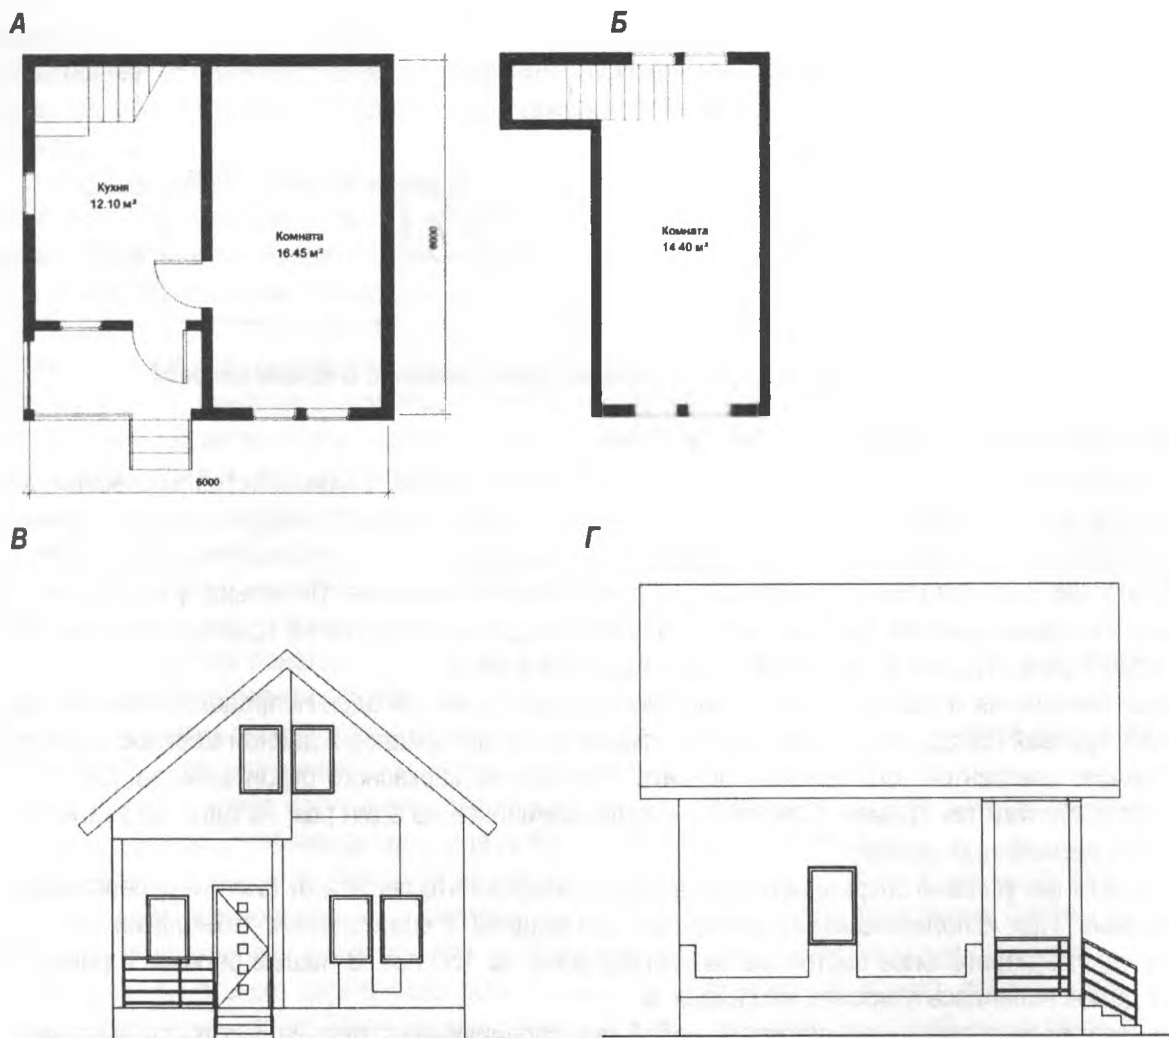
А-план 1-го этажа; Б- план 2-го этажа; В-фасад фронтальный; Г-фасад боковой
